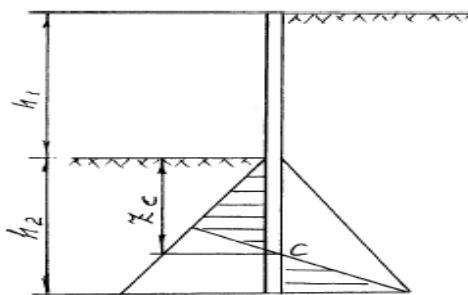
Расчетная схема тонкой незаанкеренной подпорной стены
